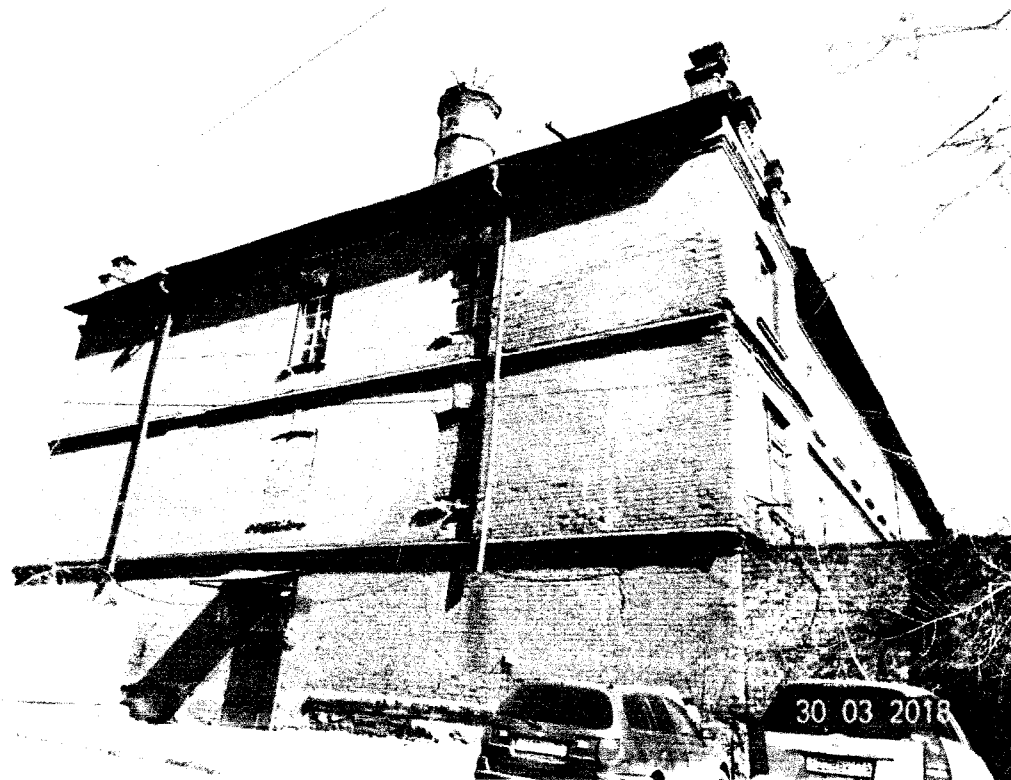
Боковой юго-западный фасад. Общий вид. Вентиляционная труба на крыше.
